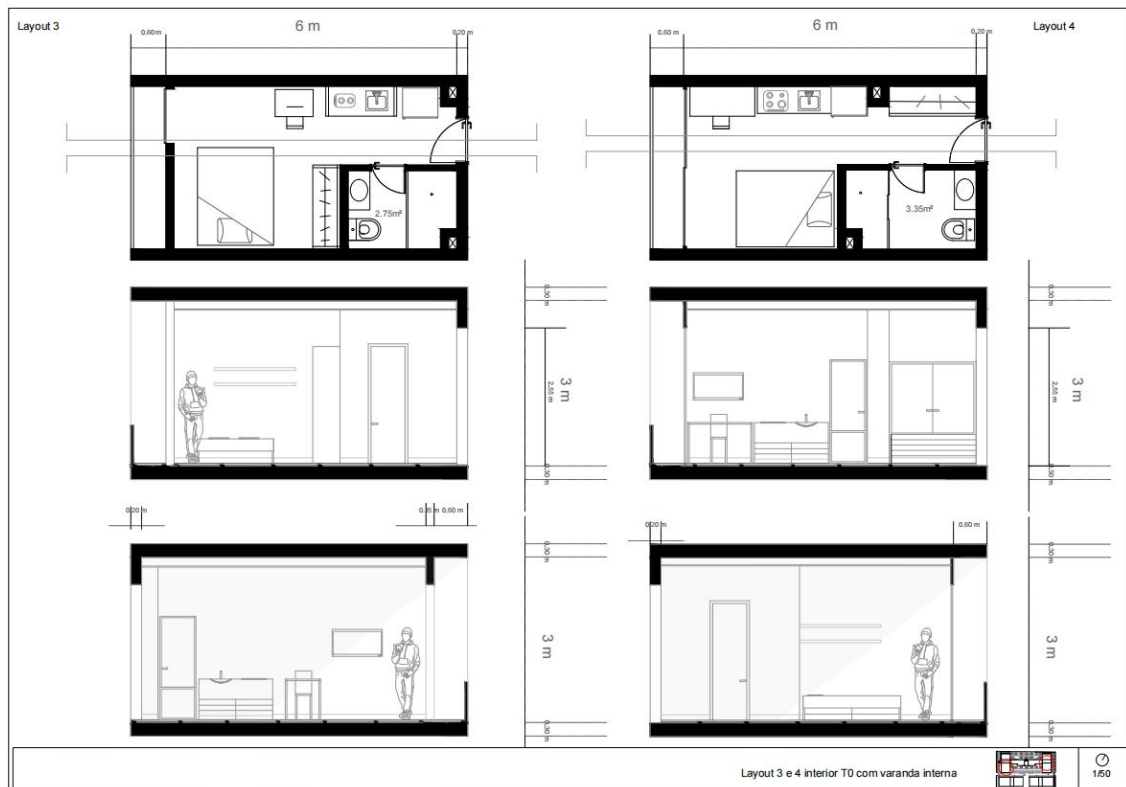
Planta do *Layouts* 3 e 4 das Unidades 1/50.
